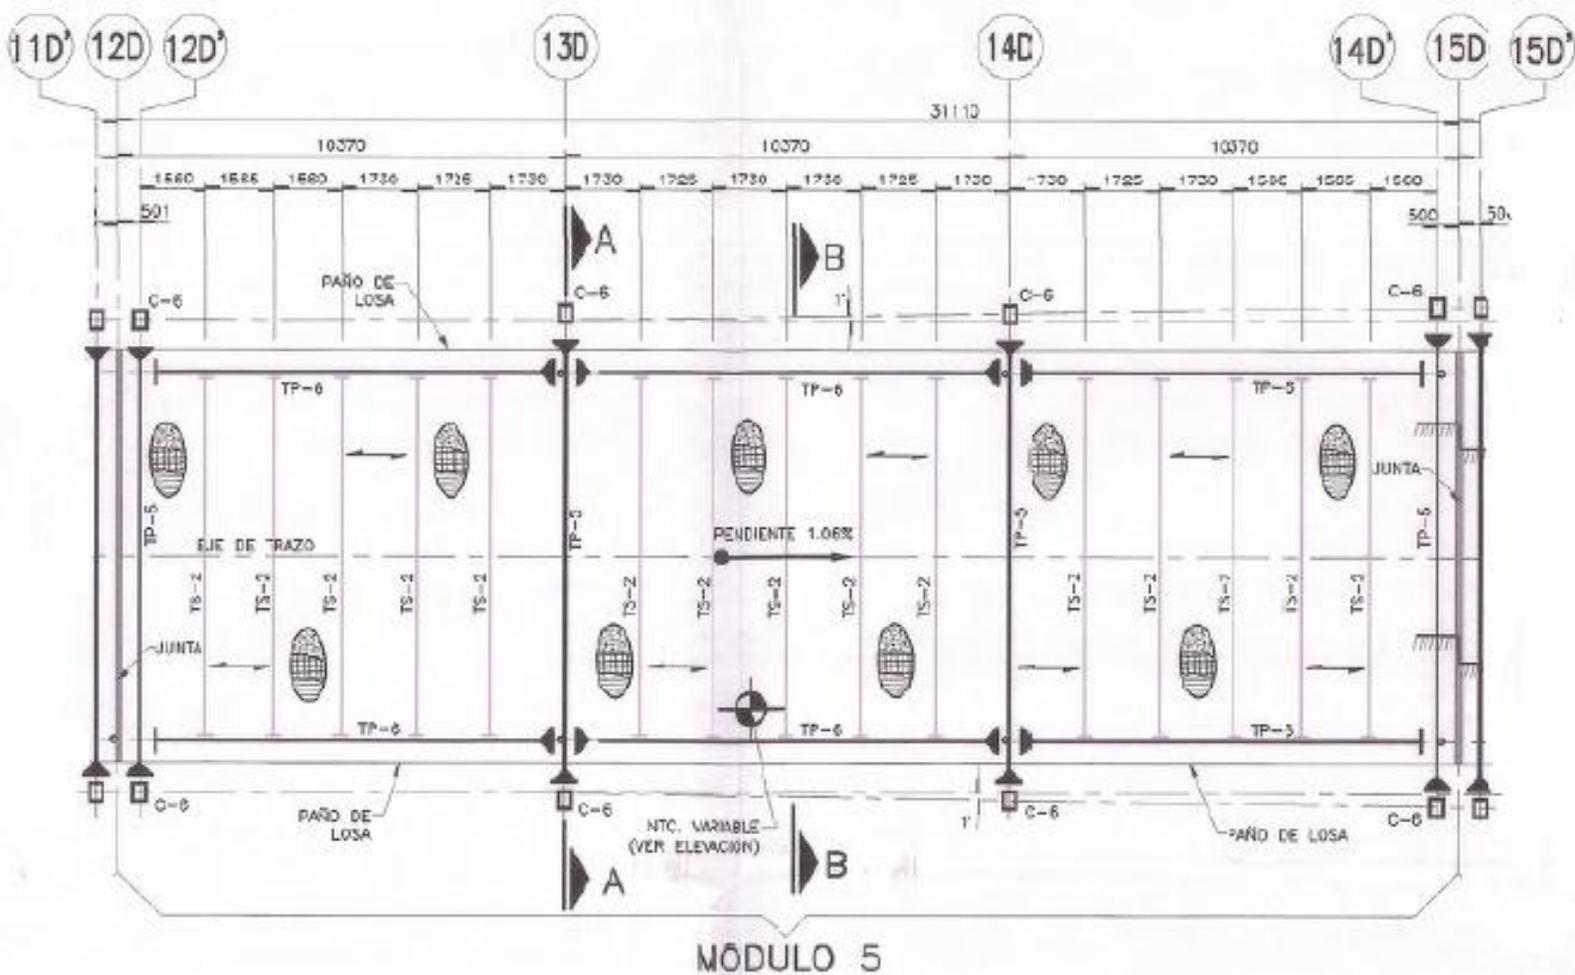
Planta de estructuración nivel azotea, módulo 5.
